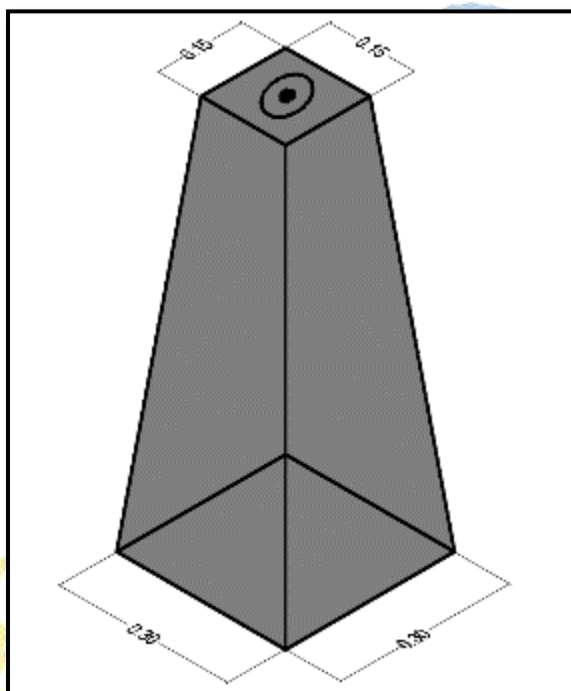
Esquema de Mojón de Concreto Reforzado para GPS
